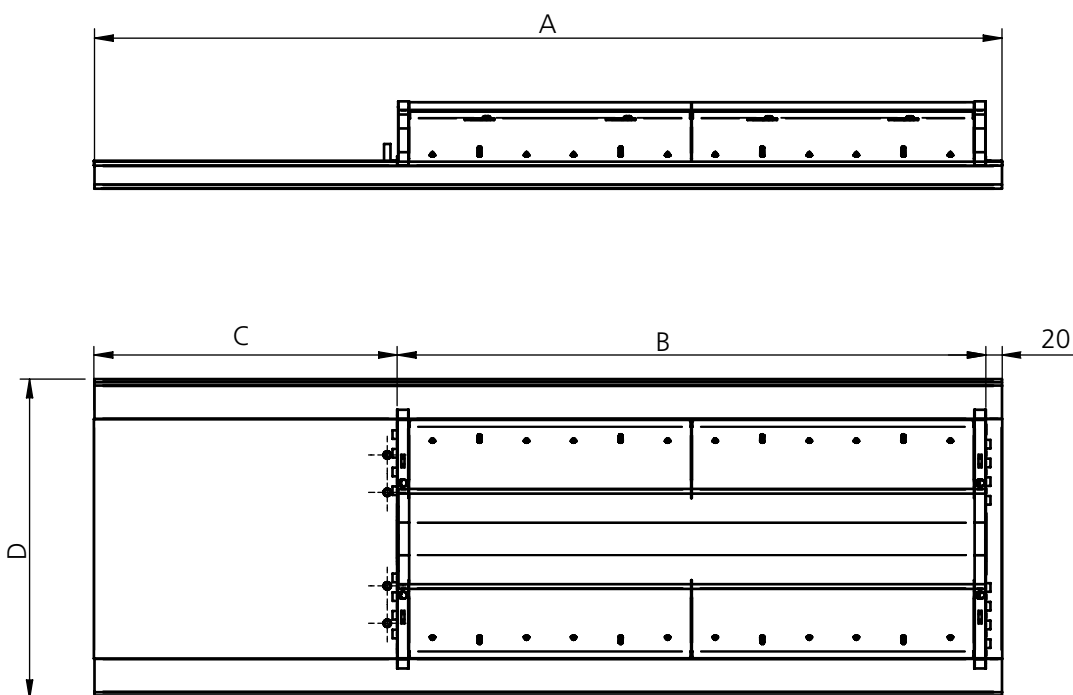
Maßskizze für das Designmodul im T-Profil mit c-c 600 mm und Leistungsmodul in Rechtsausführung – Seitenansicht und Draufsicht
